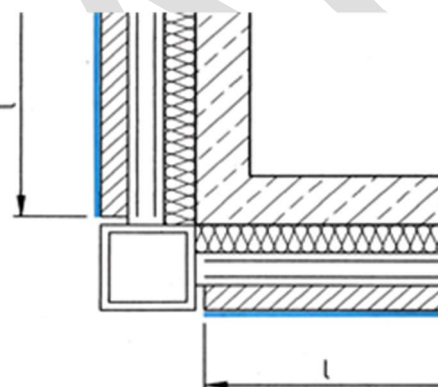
Coupe horizontale sur façade ; angle saillant - revêtement céramique butant sur un tuyau de descente
